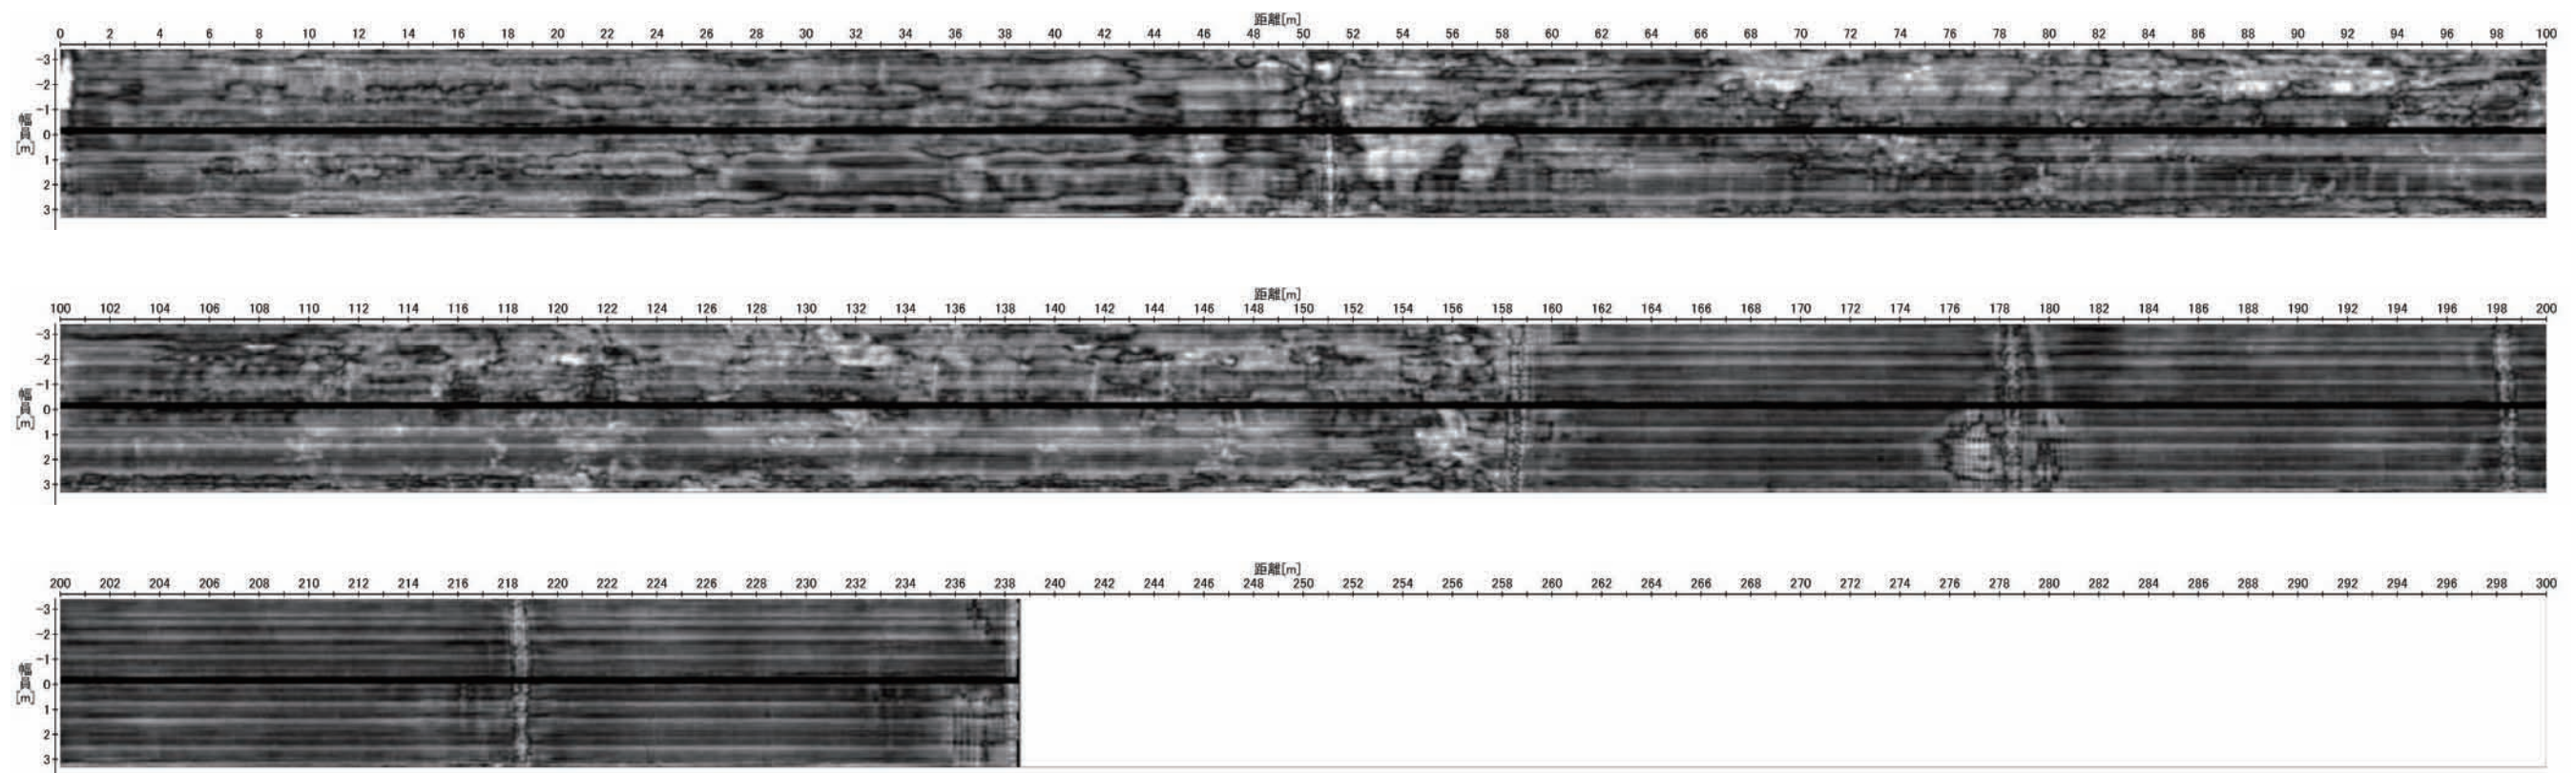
Y橋の電磁波データ（床版上面付近の平面図）
